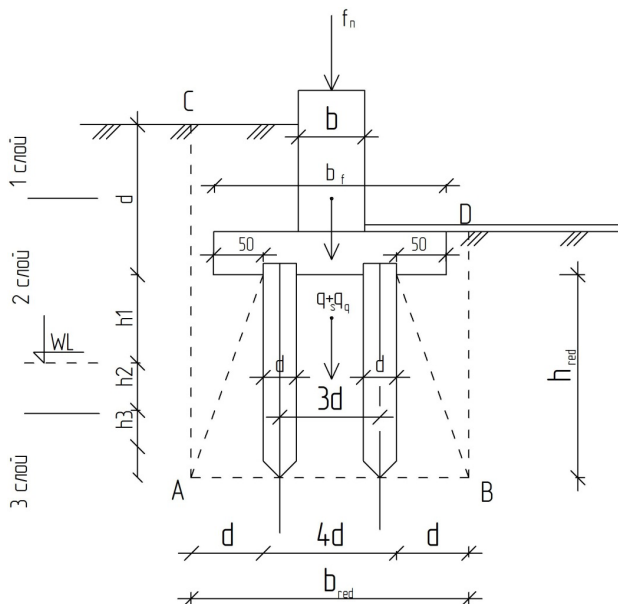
Схема определения границ условного фундамента при расчете осадок свайных фундамента
